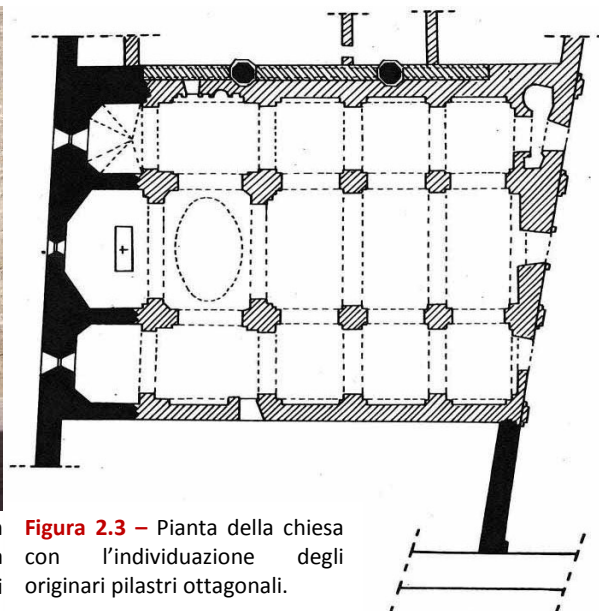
Pianta della chiesa con l'individuazione degli originari pilastri ottagonali.
